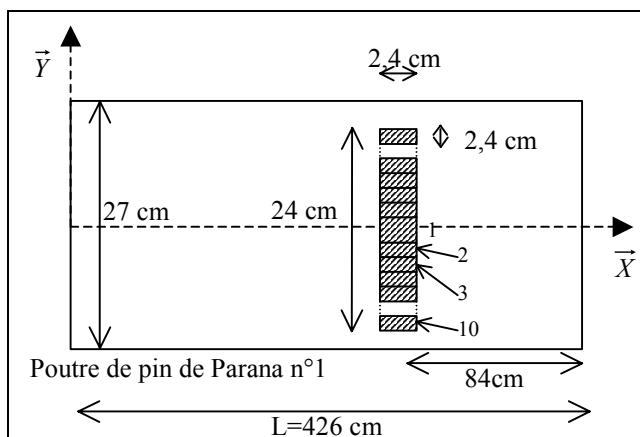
Plan de découpe des cavités dans la poutre de pin de Parana n°1.
